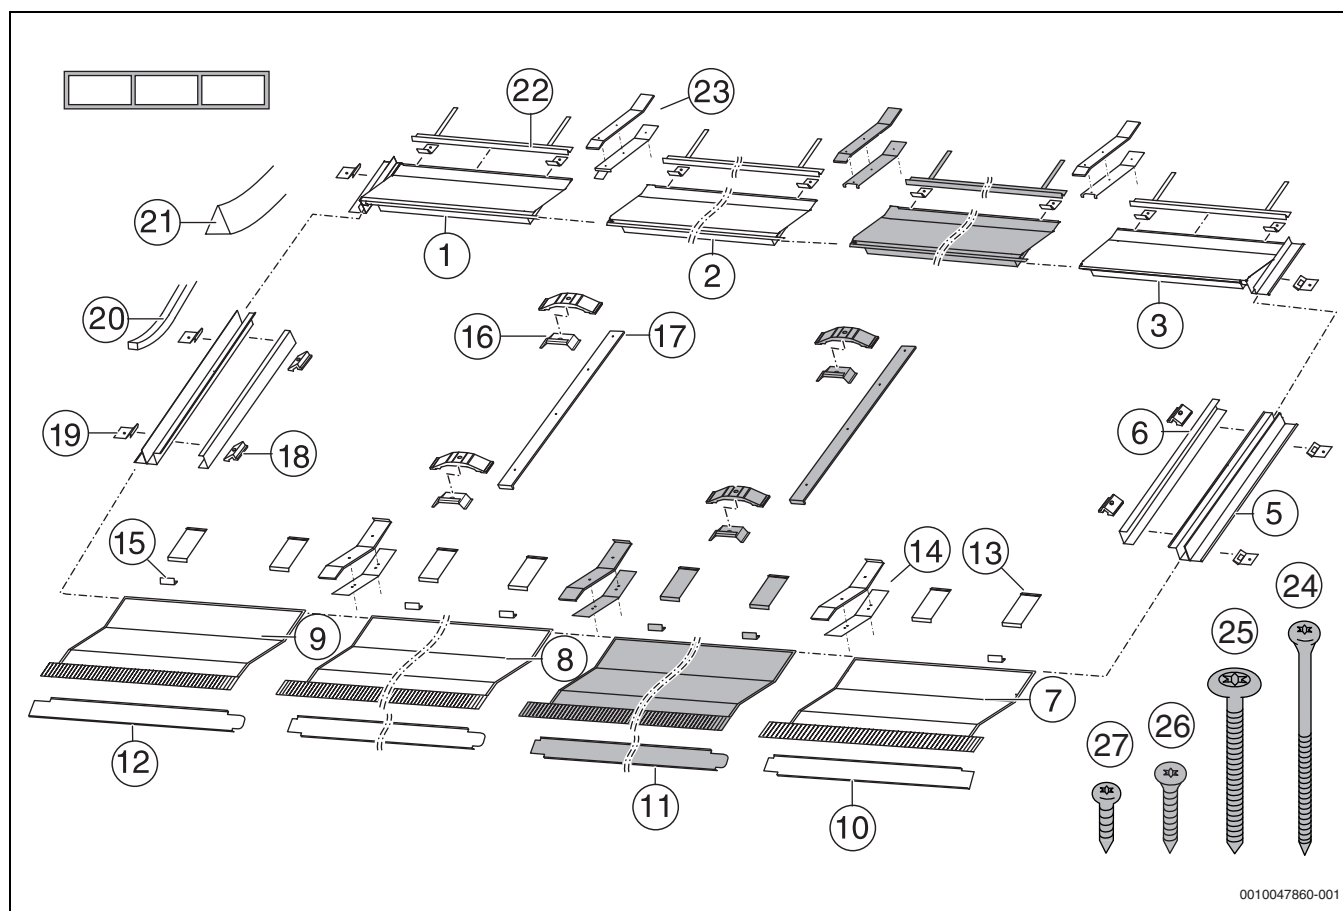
Set di fissaggio/montaggio per 3 collettori orizzontali: 1 × set di fissaggio/montaggio versione di base per i primi due collettori e 1 × set di fissaggio/montaggio di ampliamento (grigio) per ogni collettore aggiuntivo
